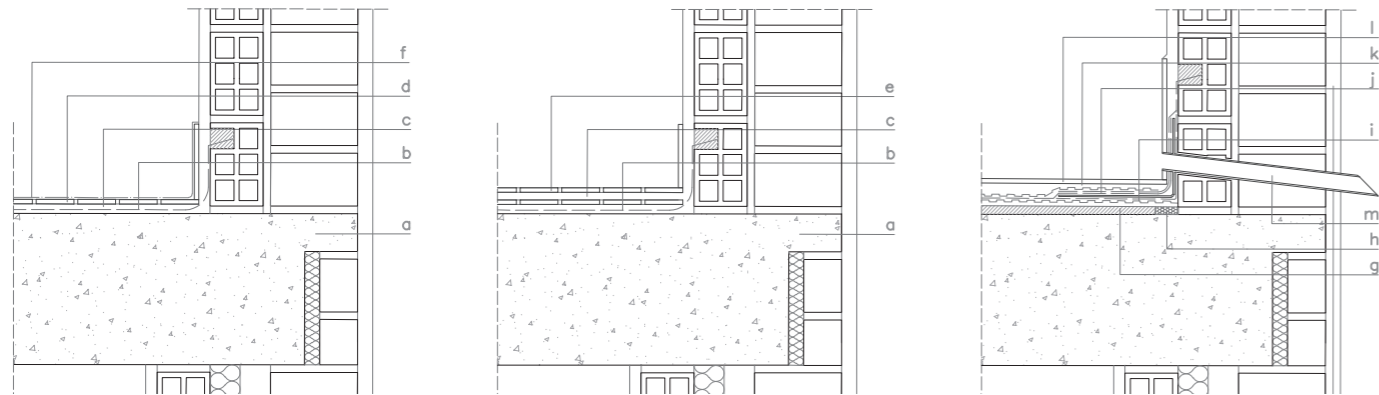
Detalle constructivo. Impermeabilización terraza áticos en encuentro con aliviadero. [Tabla 2]
